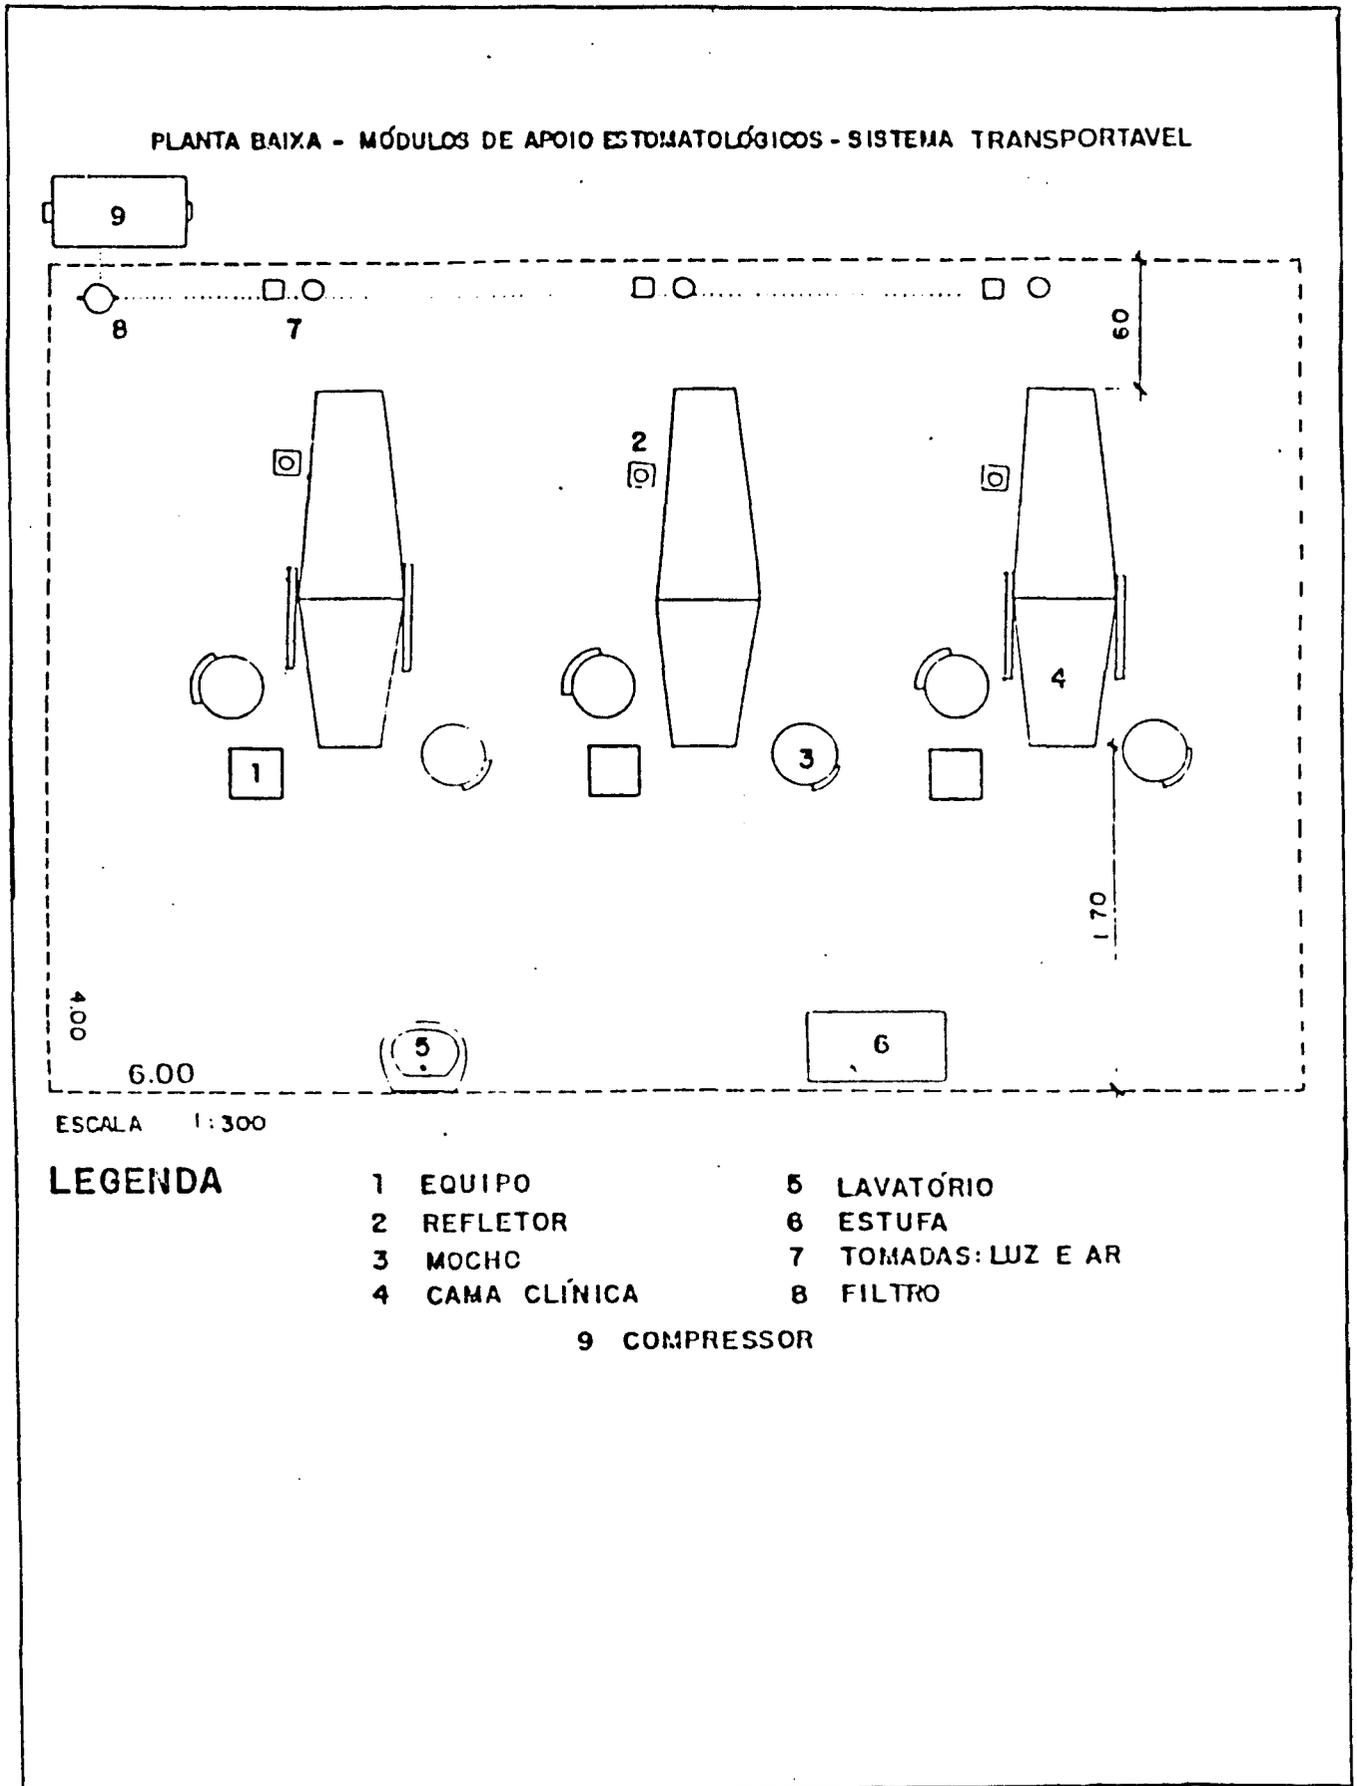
Planta baixa - Módulos de apoio - sistema transportável.
